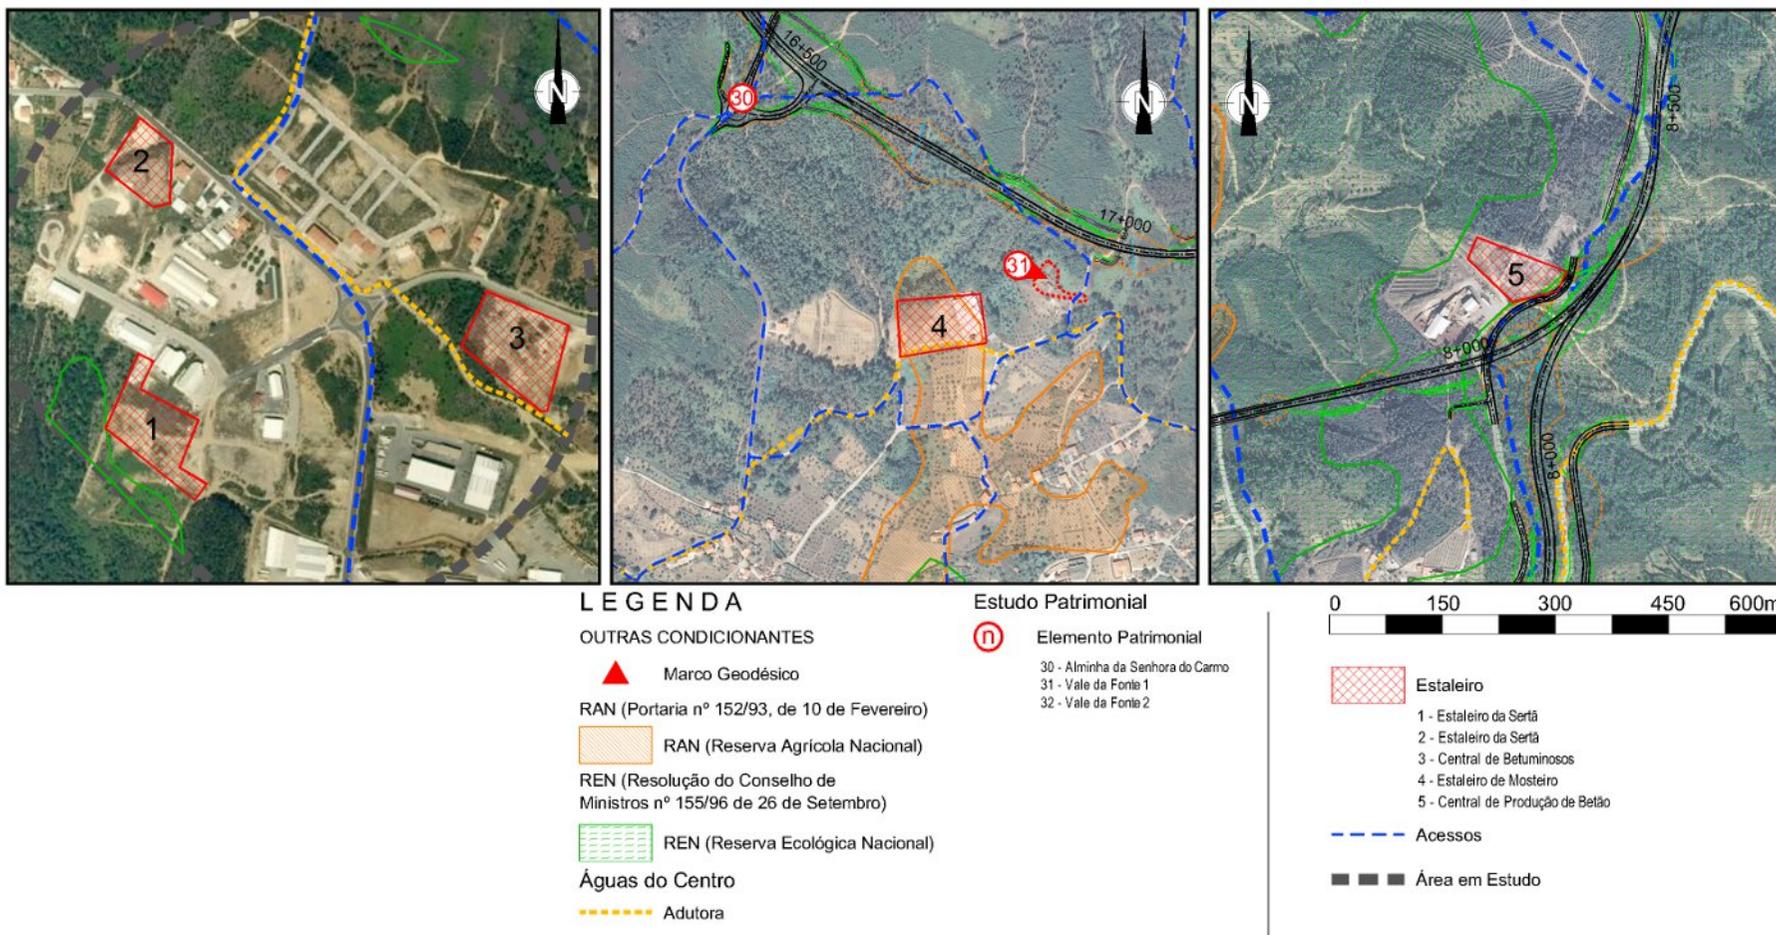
Localização prevista para a instalação dos Estaleiros, Central de Produção de Betuminoso e Central de Produção de Betão.
